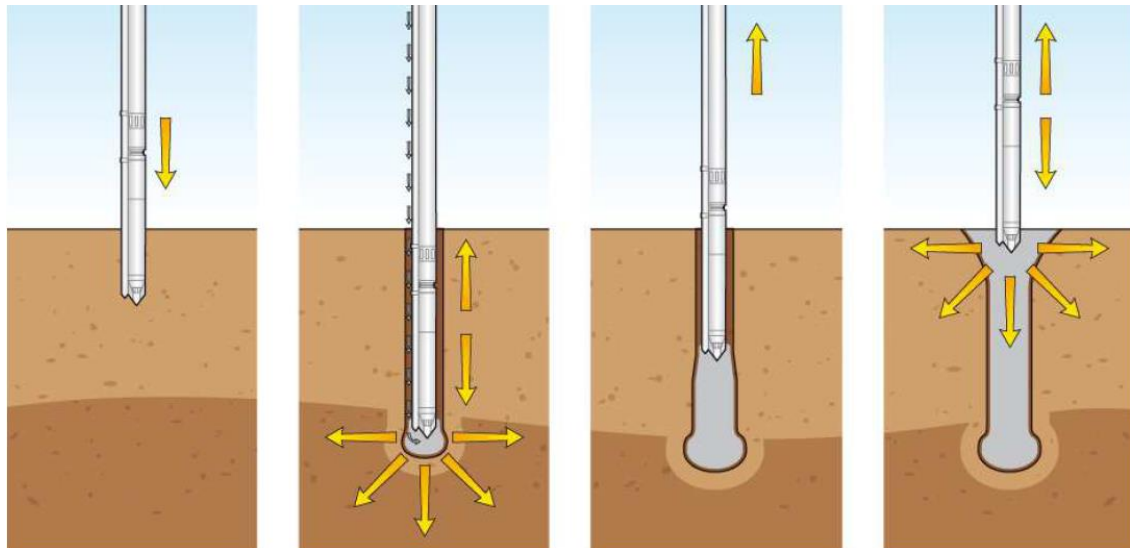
Columnas de concreto vibrado (Balfour Beatty, 2017)
